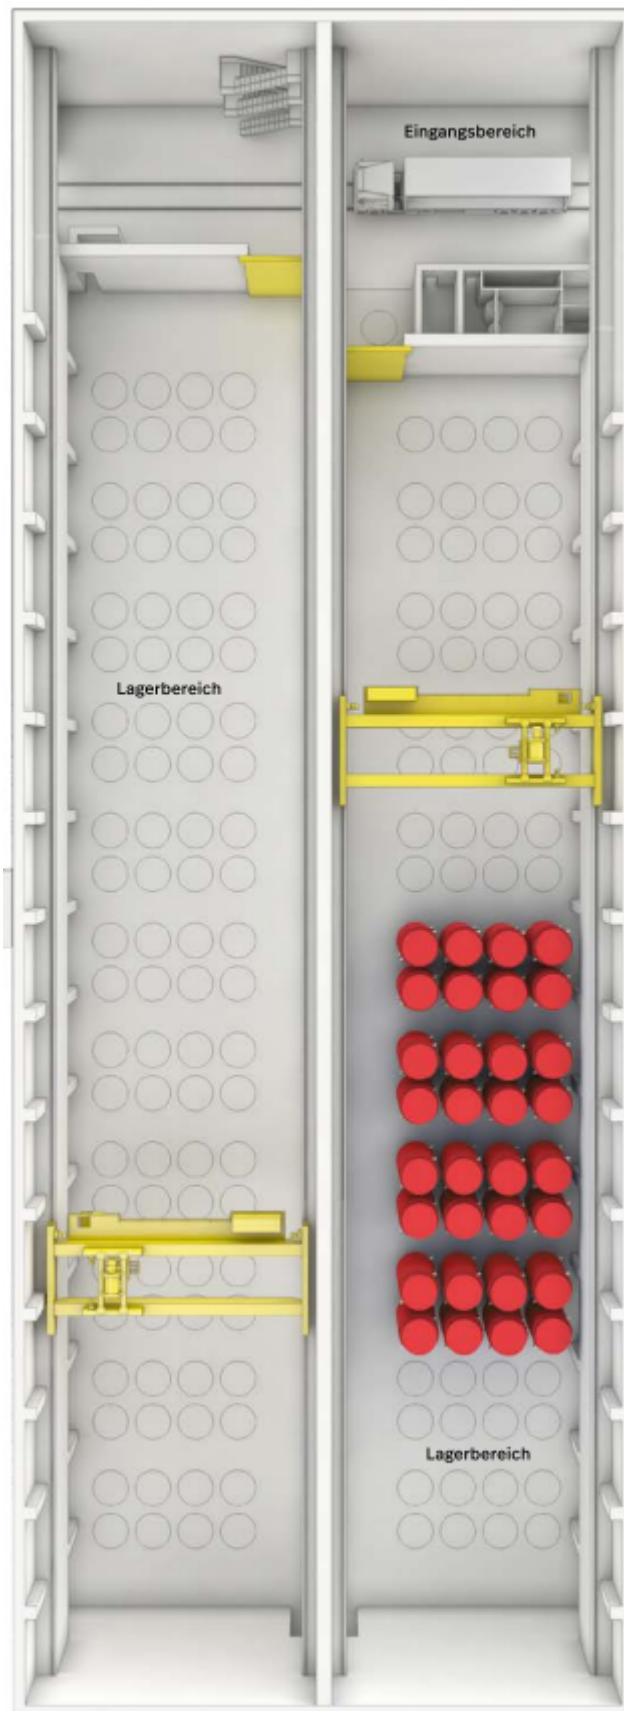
Lagerhalle nach dem WTI-Konzept
